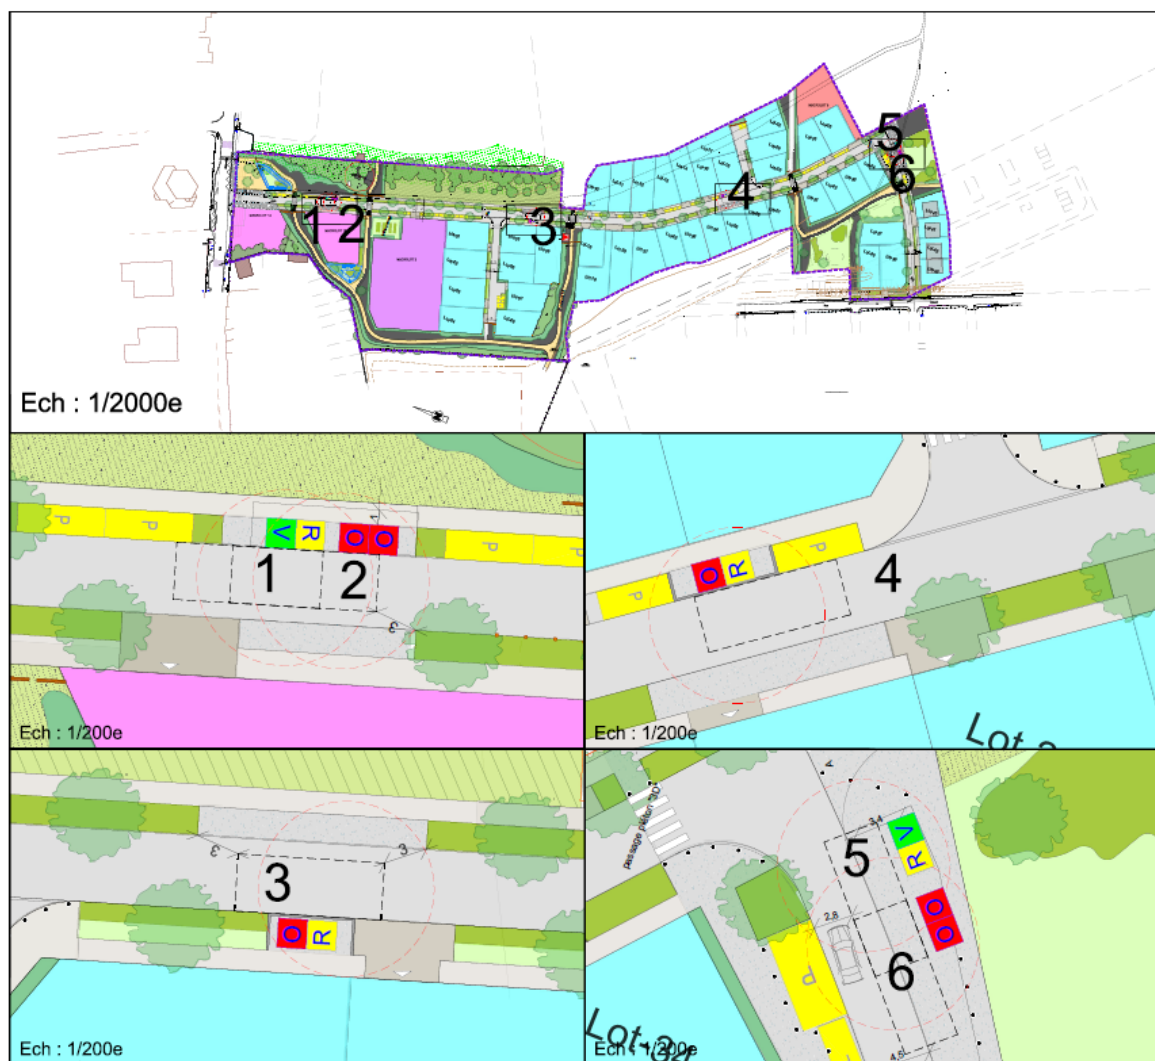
Plan de localisation des Points d'Apports Volontaires
